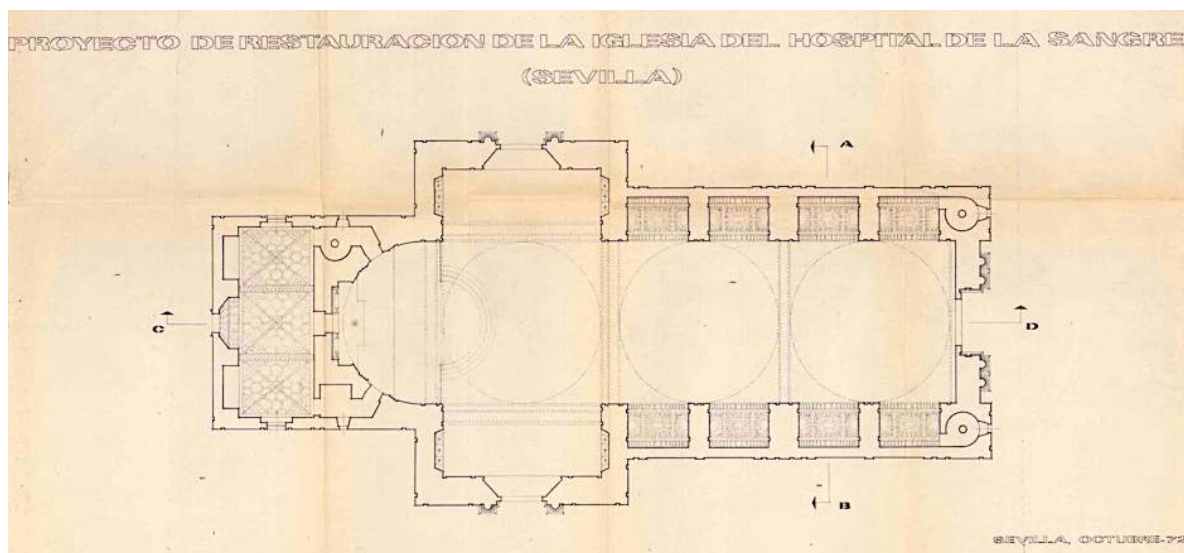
Proyecto de Obras de Restauración de la Iglesia del Hospital de la Sangre de Sevilla, 1973.
